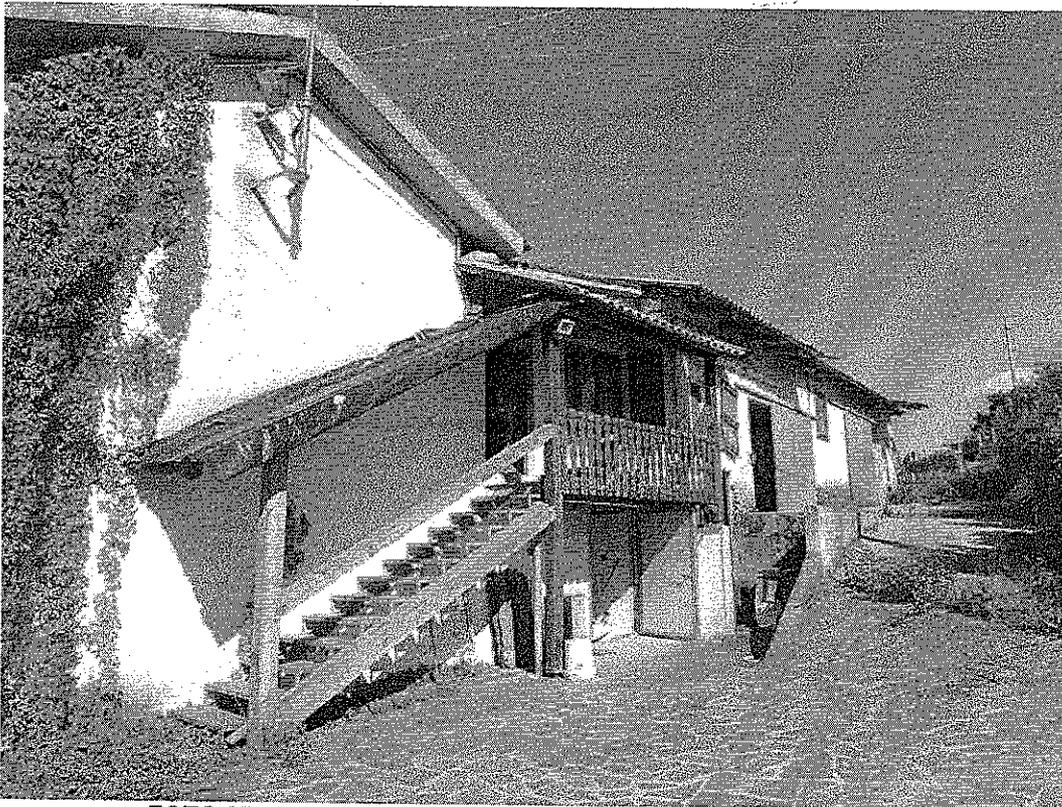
prospetto Est, accesso abitazione piccola al piano primo
